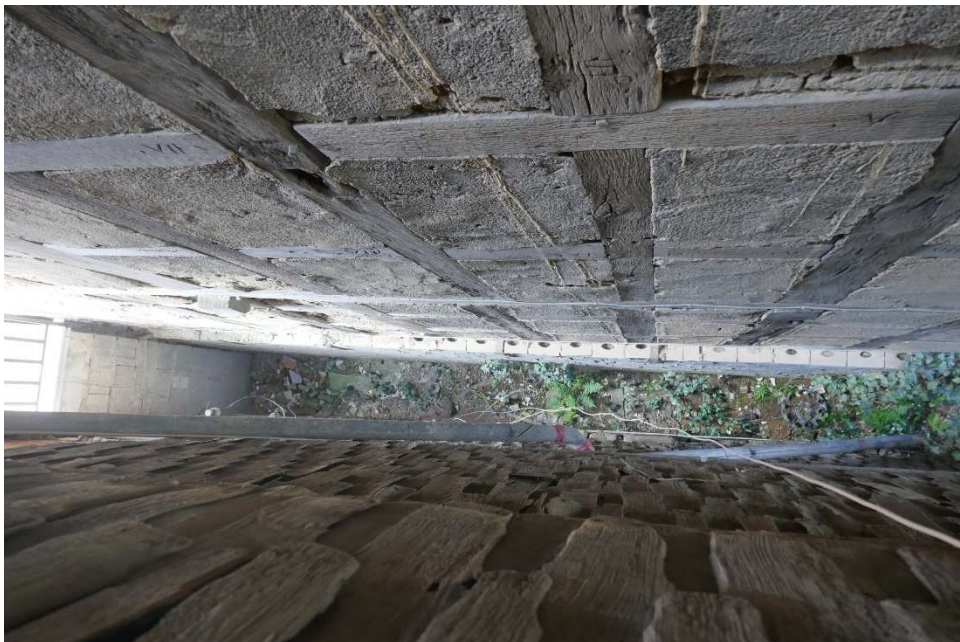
Bauwich zum Nachbargebäude auf der Gebäude-Westseite
